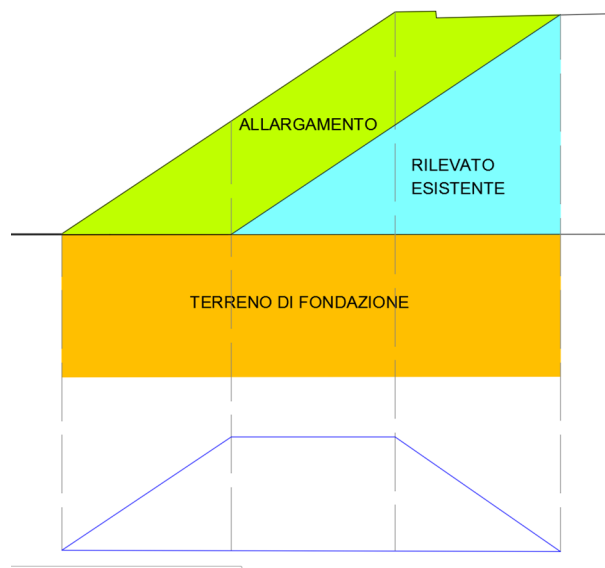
SCHEMA DI RIPARTIZIONE IN PIANO DEL CARICO INDOTTO DALL'ALLARGAMENTO
